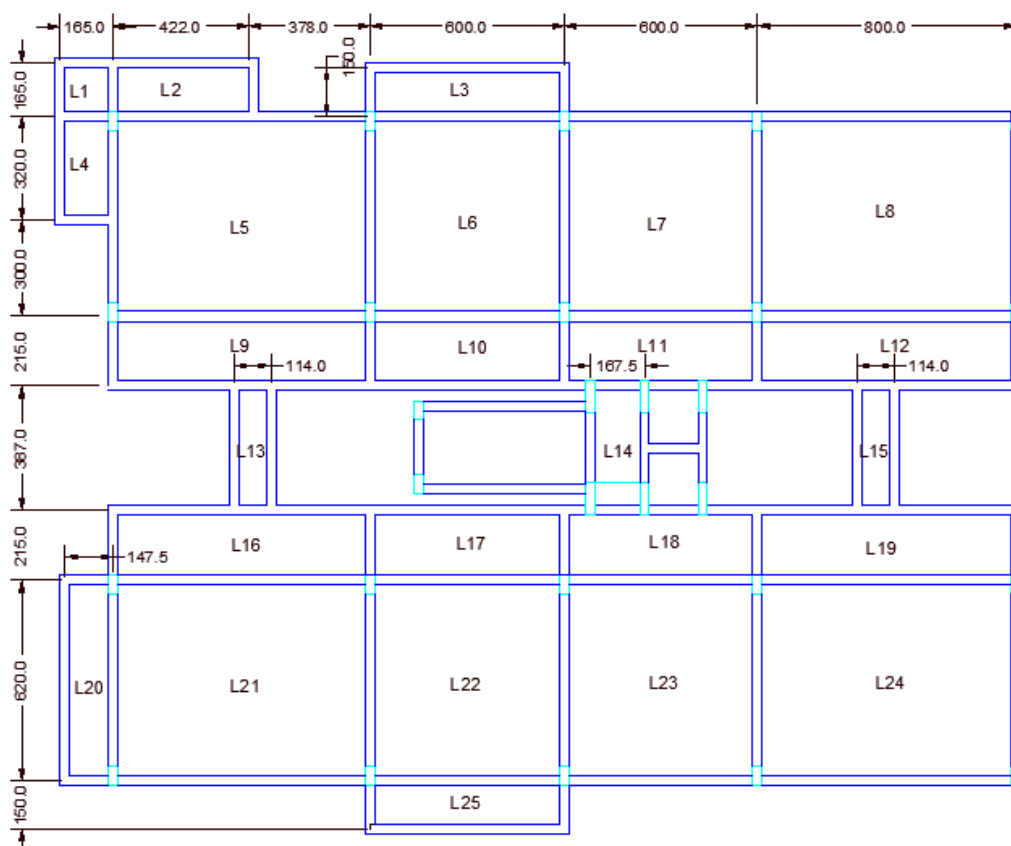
Lançamento da estrutura do pavimento PT5 no CAD/TQS
